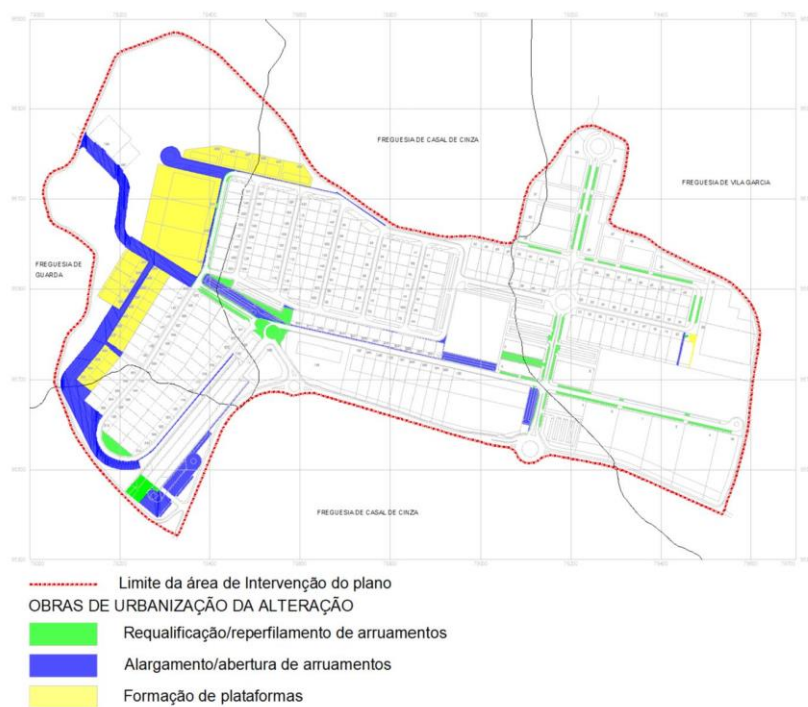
Obras de urbanização da execução da alteração do Plano
